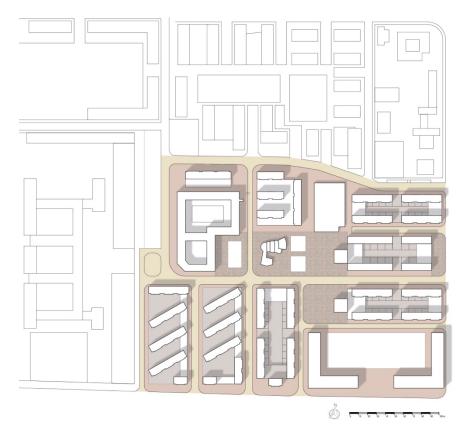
Plano de planta baja y comercios 2. Fuente: elaboración propia.
